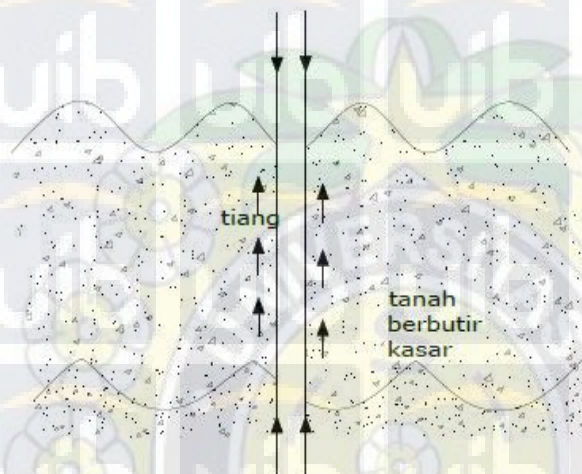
Pondasi Tiang Pancang Dengan Tahanan Ujung
